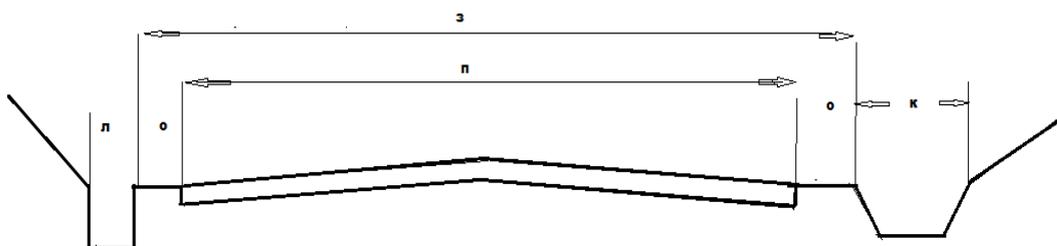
Поперечное сечение нижнего основания капитальной траншеи:
